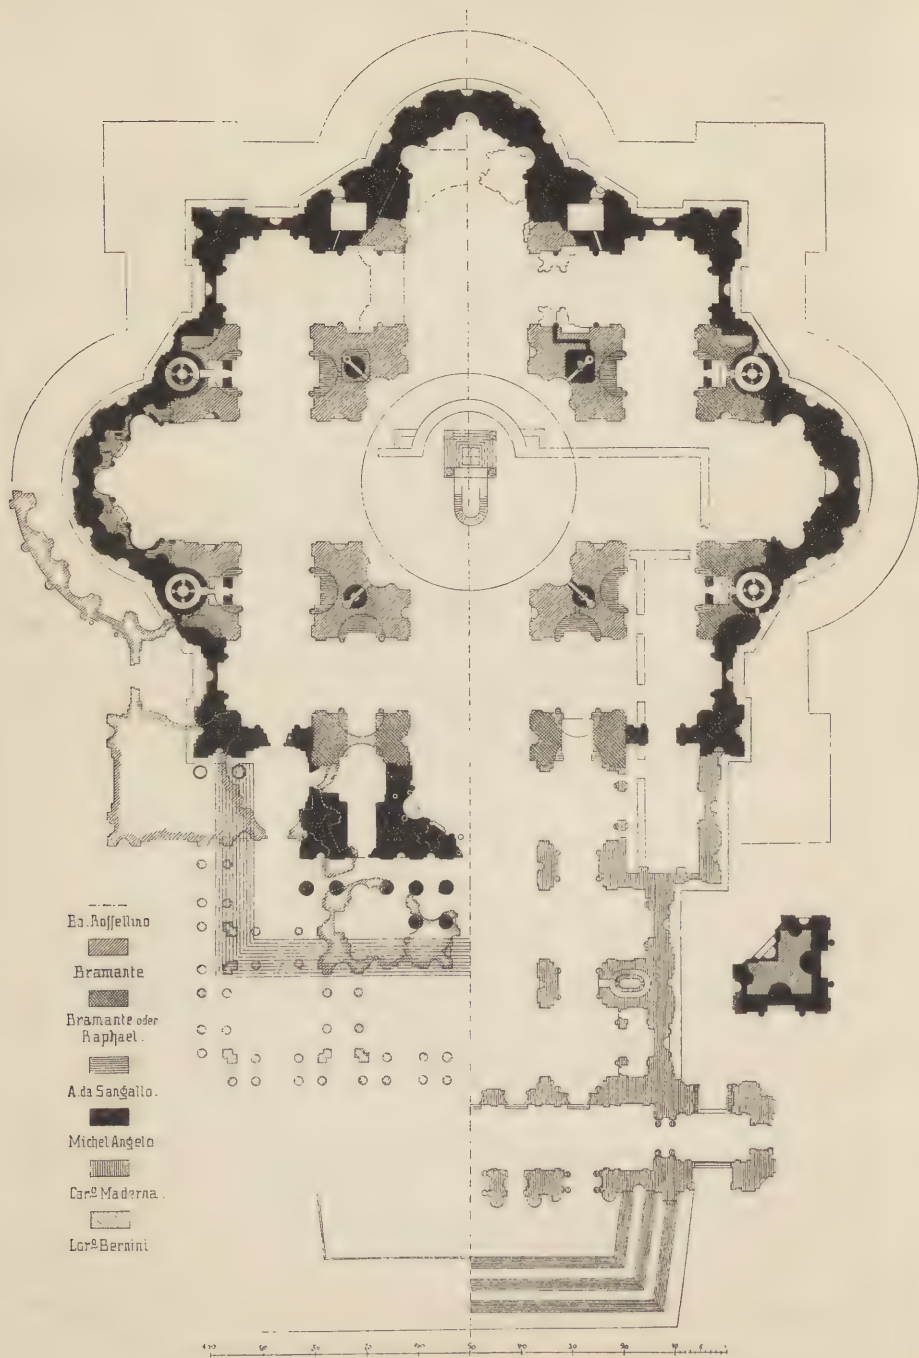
St. Peter zu Rom. Darstellung der Grundrissentwicklung.
